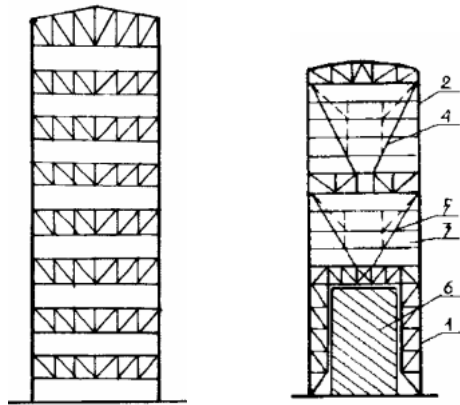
А – сталевий каркас багатоповерхової будівлі без внутрішніх колон; Б – поперечні сталеві рами будівлі, в яких здійснюється реконструкція з надбудовою поверхів (до 15 поверхів); 1 – нижня секція рами; 2 - верхня секція; 3 – середня секція; 4 – елементи жорсткості; 5 – підвіска; 6 – існуюча будівля, яку надбудовують.
